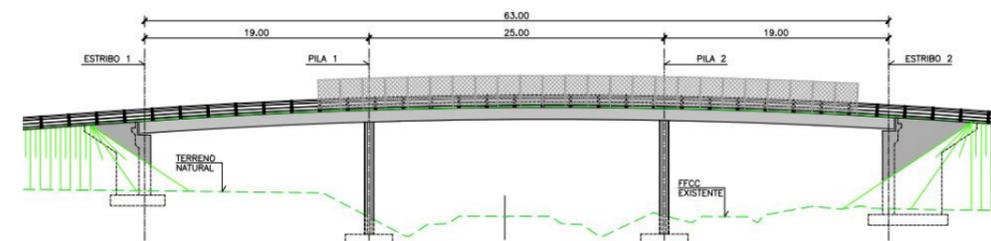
ALZADO DEL PASO SUPERIOR P.K. 1+330
